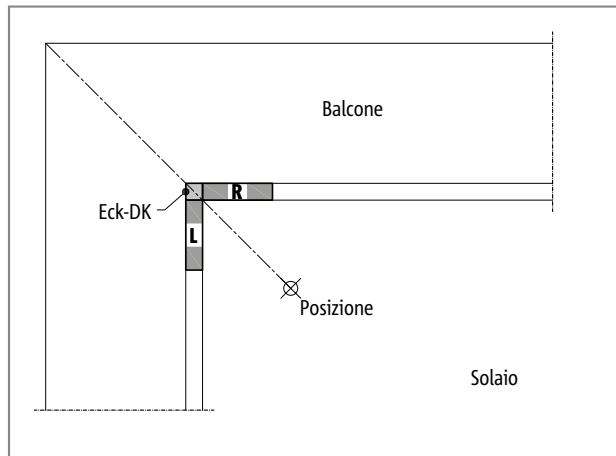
Schöck Isokorb® tipo EXT: disposizione EXT-L a sinistra della posizione; disposizione EXT-R a destra della posizione
